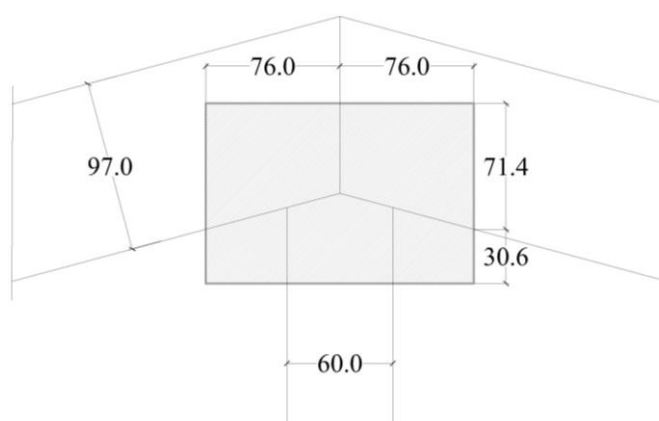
Geometria da ligação e dimensões da chapa metálica em mm
